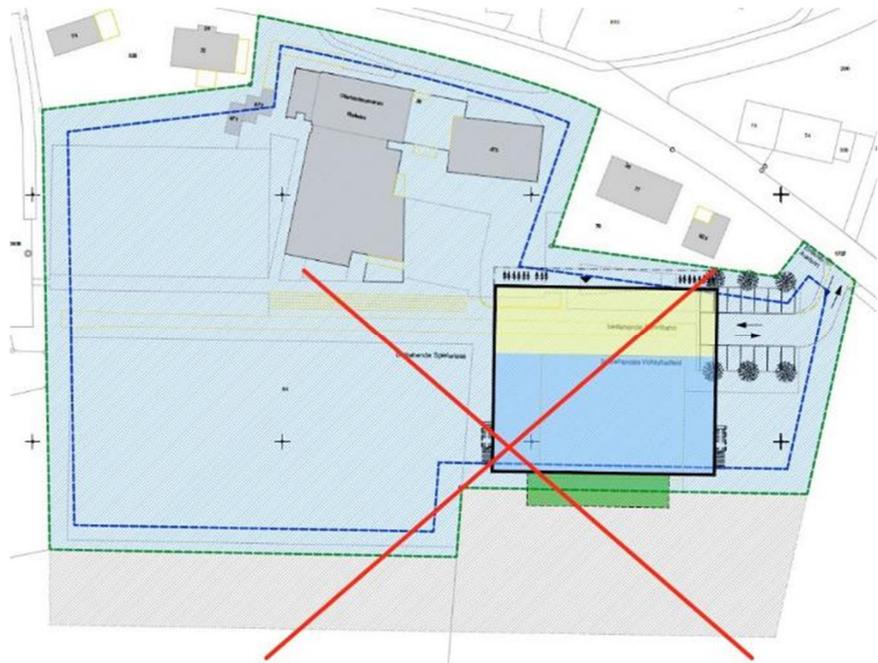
Neubau Doppelhalle B aufgrund Platzmangel auf Parzelle Nr. 51 nicht möglich
